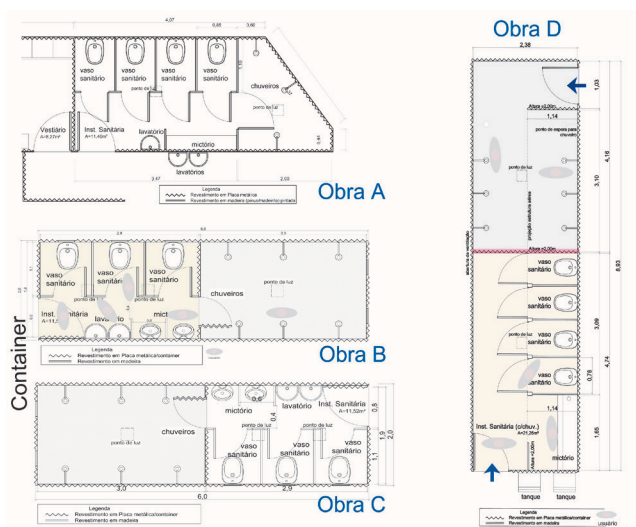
Layout das instalações sanitárias das obras A, B, C e D.
